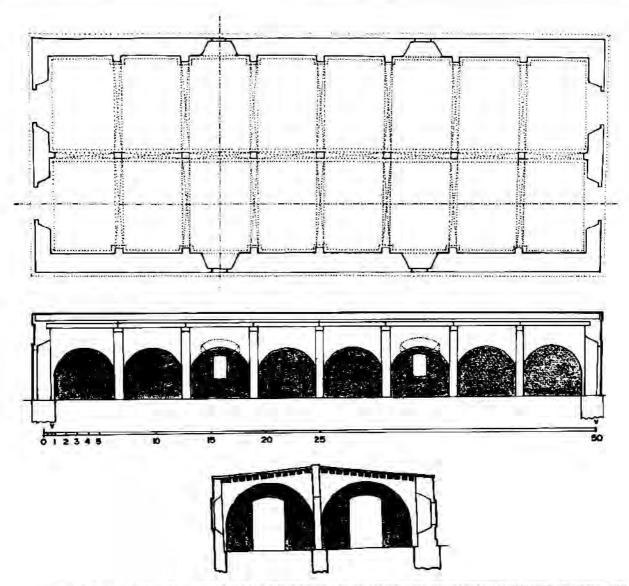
PLANO Y PERFILES DEL TINGLADO PARA LA CONSERVACION DE LAS MADERAS DEL REY, PROPUESTA POR MANUEL DE SANTIESTEVAN EL 6 DE MAYO DE 1764
